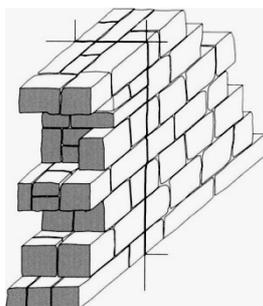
Ligante forte normalmente aplicado a alvenarias de argamassa de cimento. (Paulo Ferreira, 2013)
